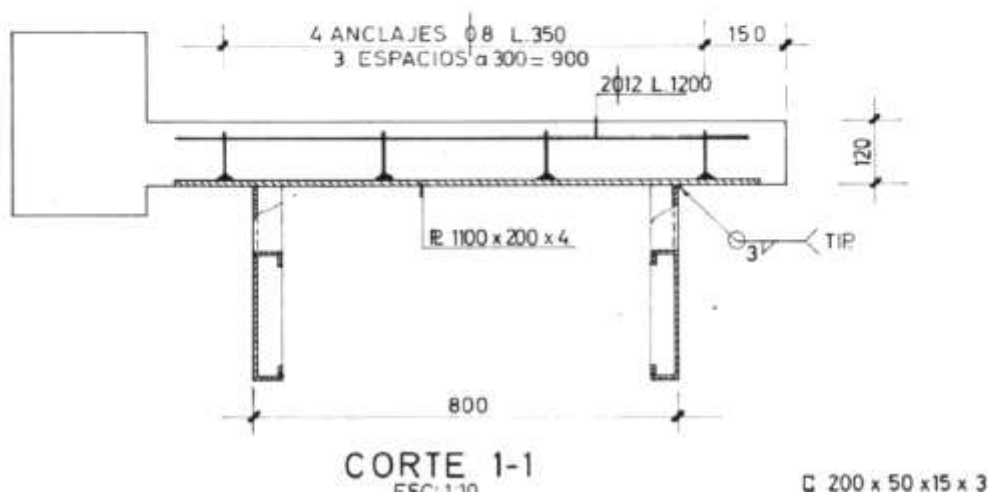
Detalle del plano original, losa del tercer piso (cubierta). Fuente: Municipalidad de Ñuñoa.
